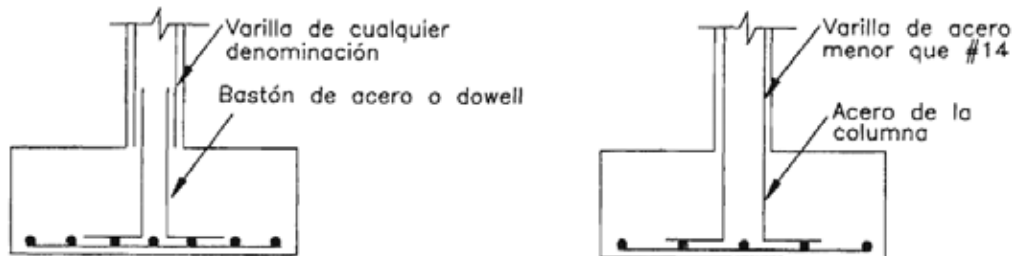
Peralte de la zapata requerido para garantizar el adecuado anclaje del refuerzo de la columna
